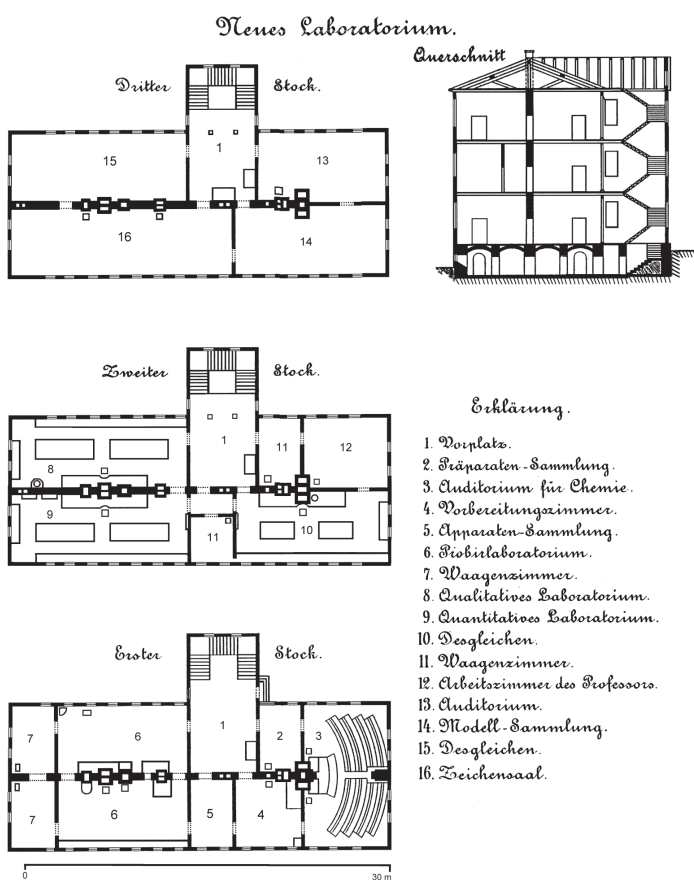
Grundriss des Chemischen Laboratoriums
